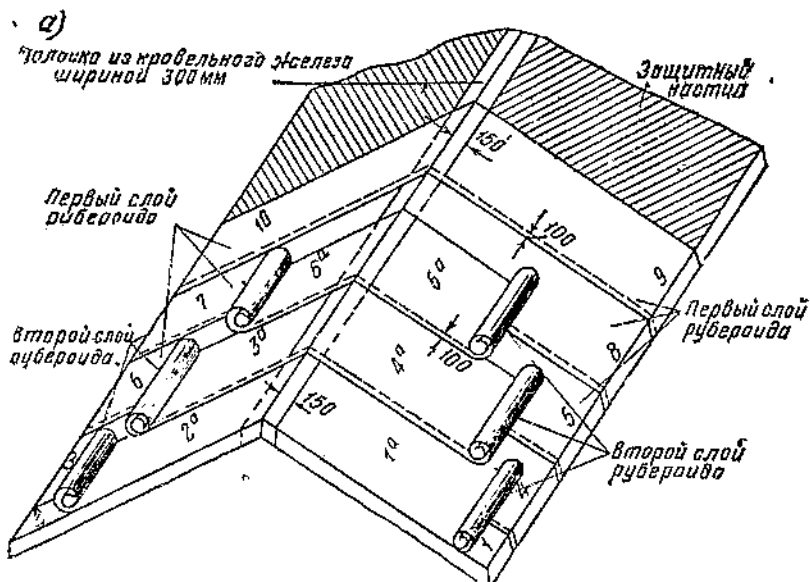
Порядок укладки полотнищ при покрытии двух-слойной кровли рубероидом.
